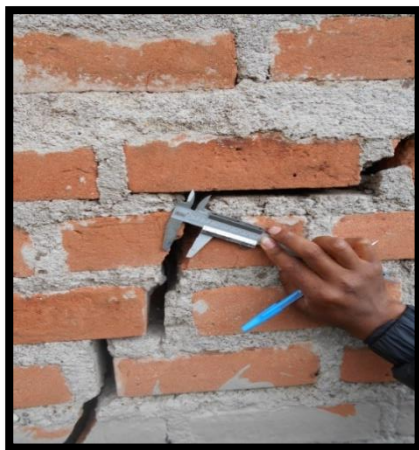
Agrietamiento fuerte en el muro de una vivienda.
